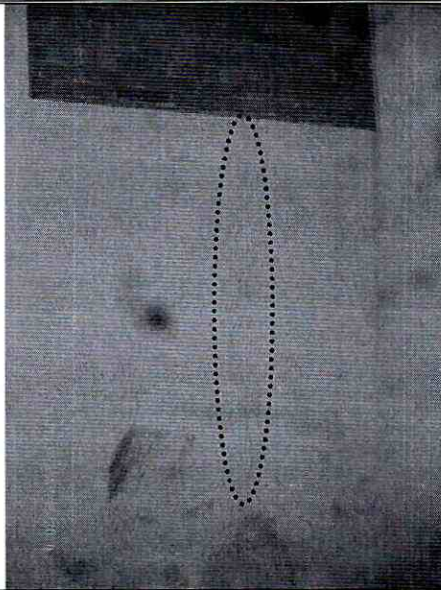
Presencia de grietas y fisuras en los muros de cerramiento de la zona de estacionamiento del Conjunto Residencial La Esperanza I y II P.H. de la Calle 163B No. 45 - 32, en el Sector Catastral Britalia de la Localidad Suba.
